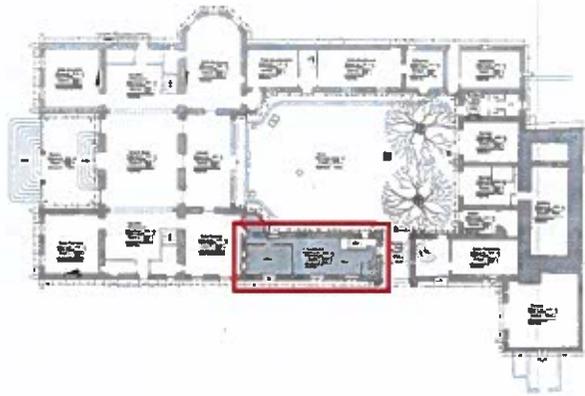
Plancher bas du rez-de-chaussée nécessitant une dépose-restitution, fond de plan transmis par SASU Atelier Cord
